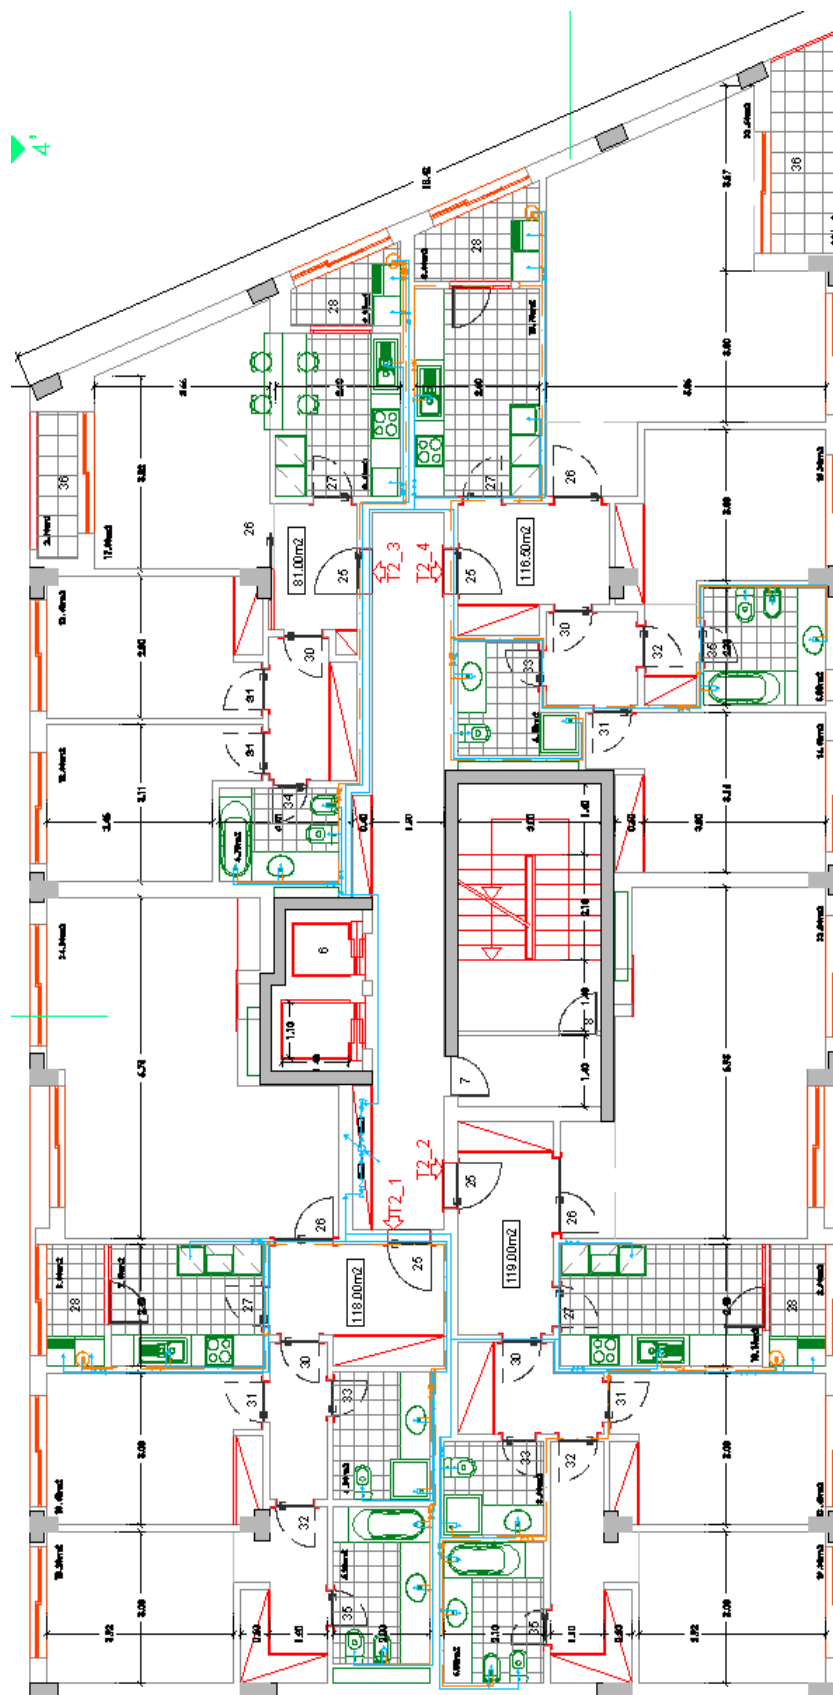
Planta do piso e indicação de cada uma das habitações
